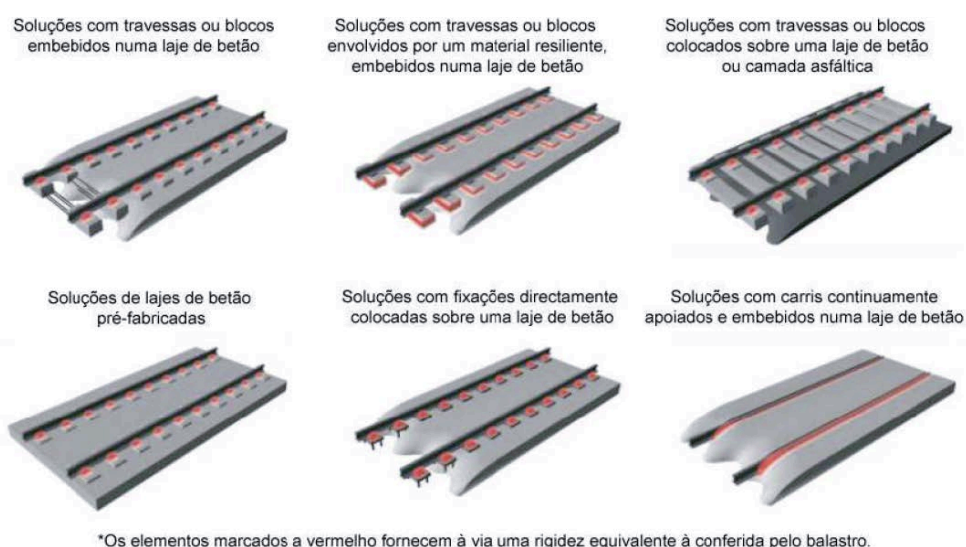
Diversas concepções de via em laje (Paixão e Fortunato, 2009)
